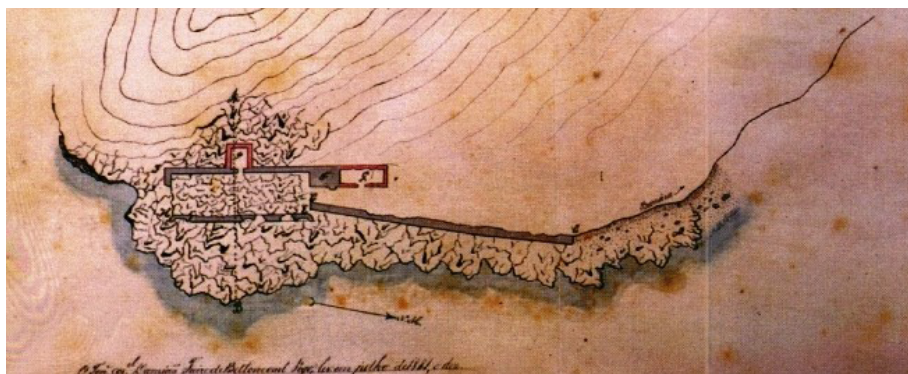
Forte da Greta, Damião Freire de Bettencourt Pego, 1881 (pormenor)
